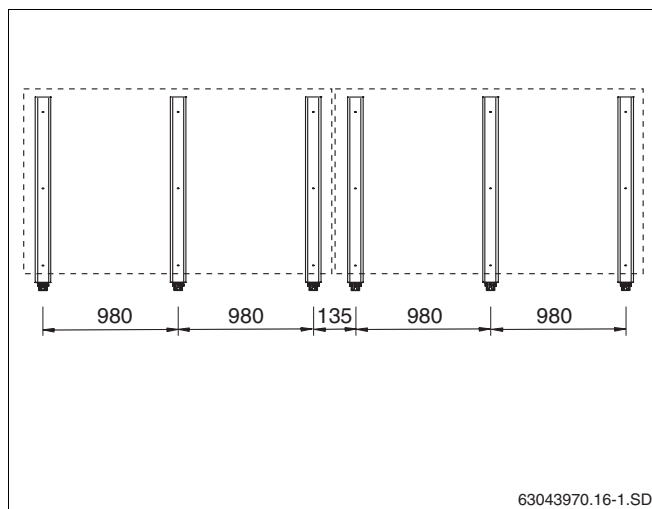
Základné prevedenie až do 10 zvislých kolektorov (údaje v mm)
